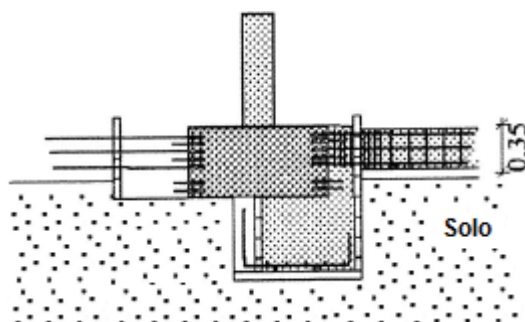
Betonagem do quadrante do recalce efetuado e da viga de travamento [adaptado de 86]
